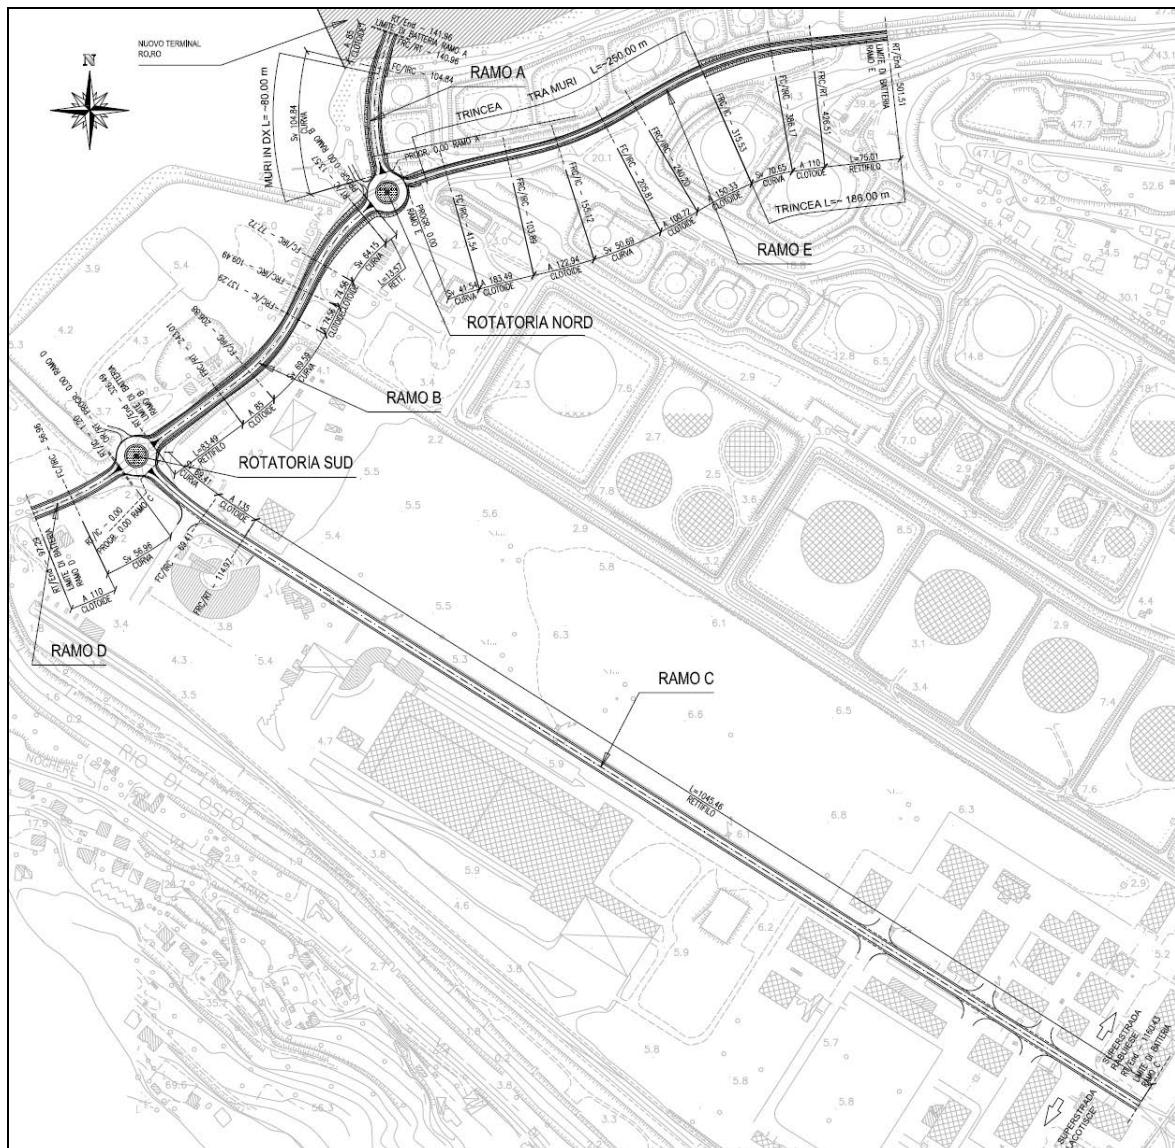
PLANIMETRIA DEL COLLEGAMENTO STRADALE CON IL TERMINAL NOGHERE
